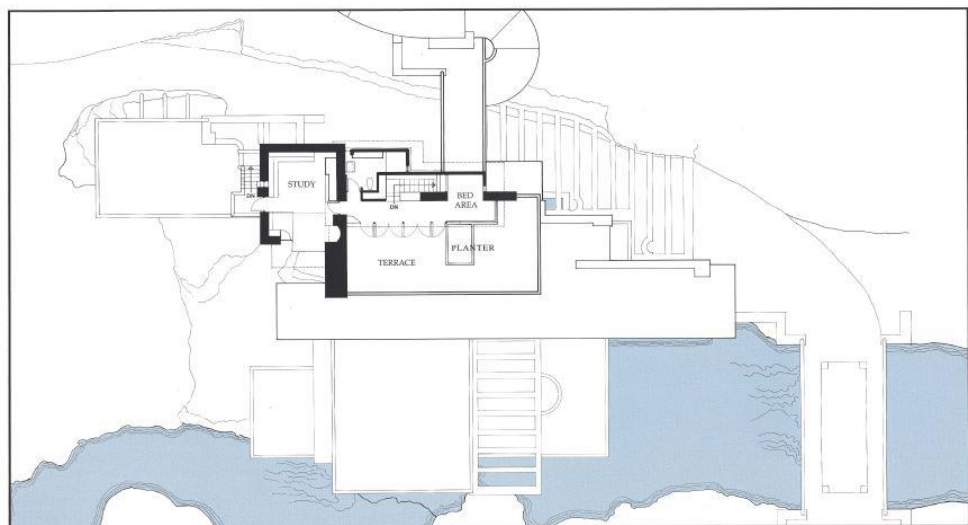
Planta do Segundo Pavimento Casa Cascata
